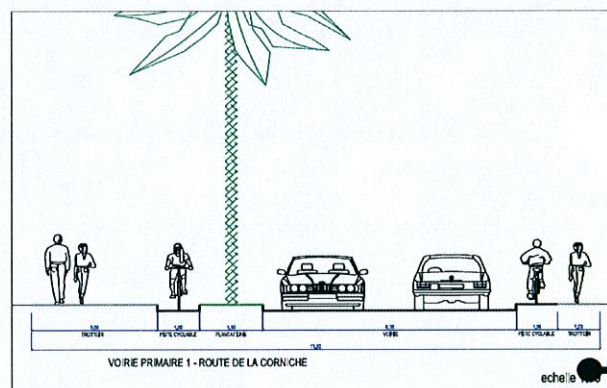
Profil en travers type Voirie primaire/Route de la corniche
